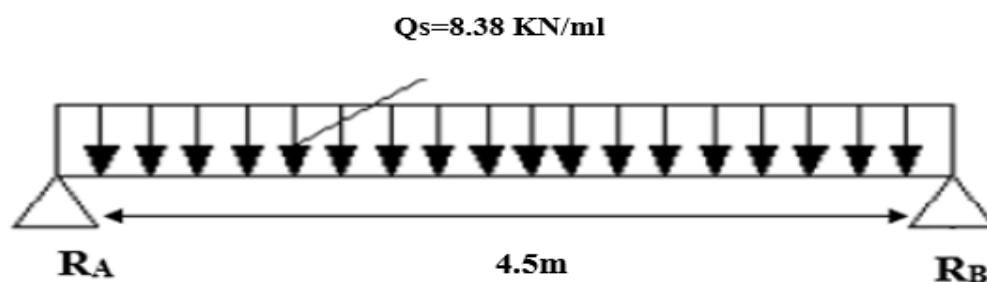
Schéma statique de la poutre chaînage à l'ELS
